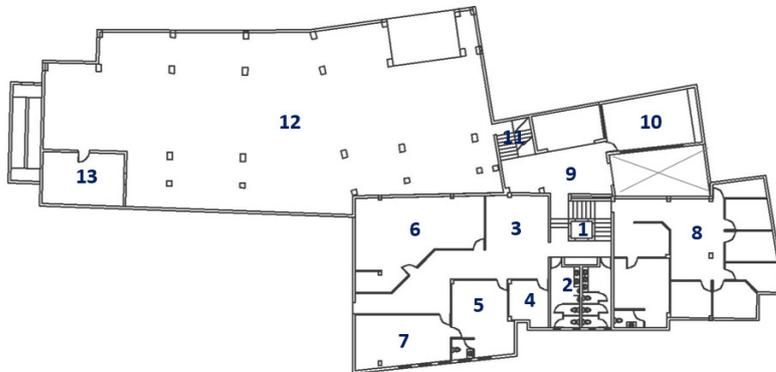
Plano de Planta Baja del Registro Público de la Propiedad y Notarías del Estado de Guanajuato. Elaboración Propia.
